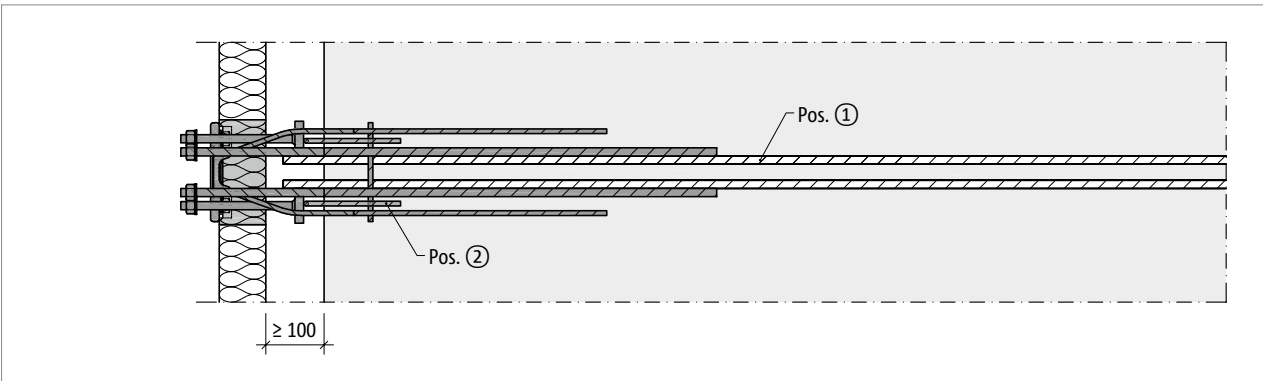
Schöck Isokorb® T Typ SKP-M1: Bauseitige Bewehrung bei Halbfertigteilbauweise, Grundriss
